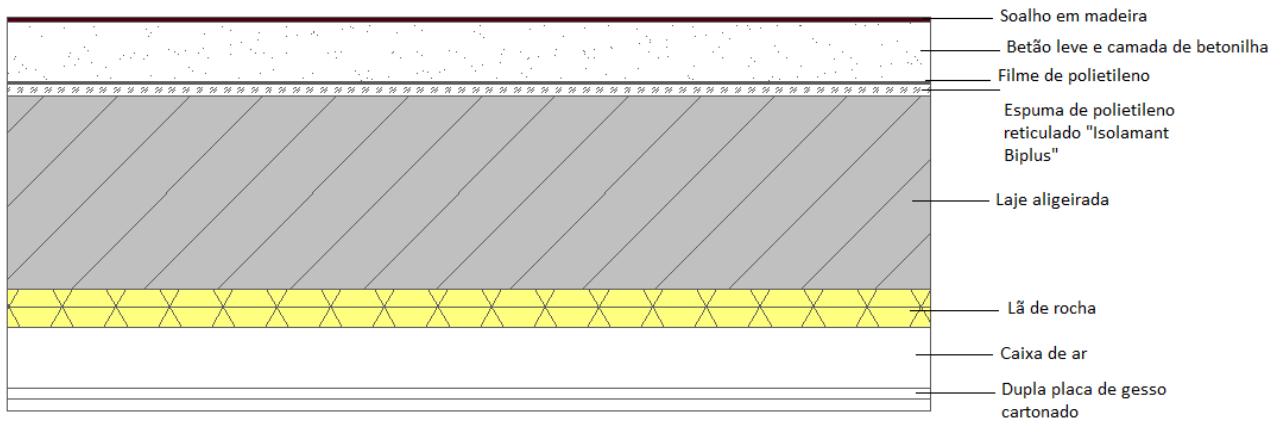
Pormenor construtivo do pavimento entre habitação e comércio
